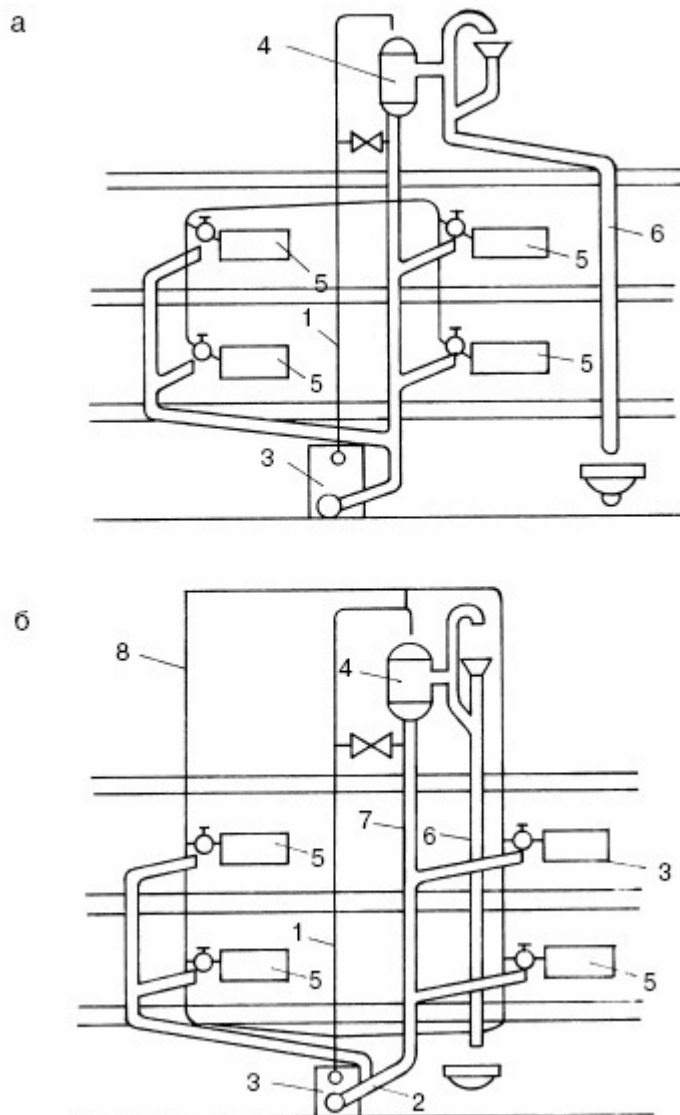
Двухтрубная схема водяного отопления: а – с верхней разводкой; б – с нижней разводкой; 1 – главный стояк; 2 – обратный трубопровод; 3 – котел; 4 – расширительный бак; 5 – нагревательные приборы; 6 – перелив; 7 – предохранительный трубопровод; 8 – воздушная труба
